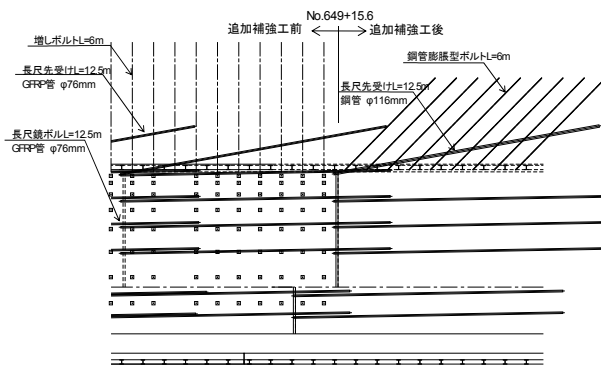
追加地山補強工を採用した施工パターン図(縦断面図)
